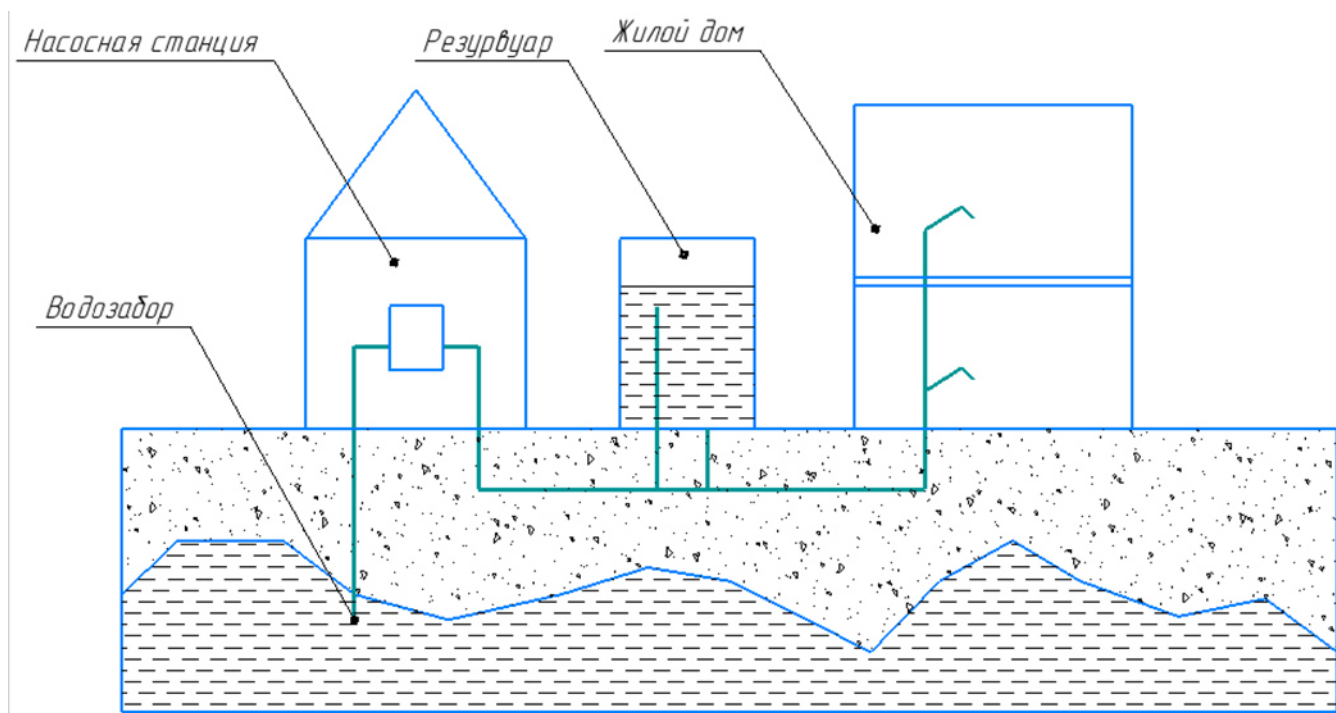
Принципиальная схема водоснабжения с. Зольное (1 вариант)
